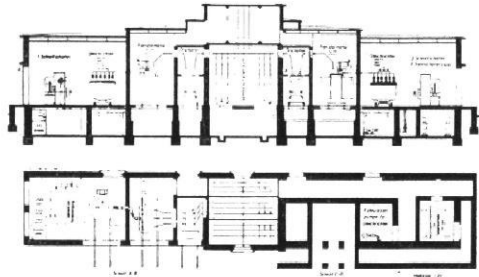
und 27 (Mitte) / Der „Regelentwurf“ für Kleingleichrichterwerke / Grundriß und Schnitt 1:500
